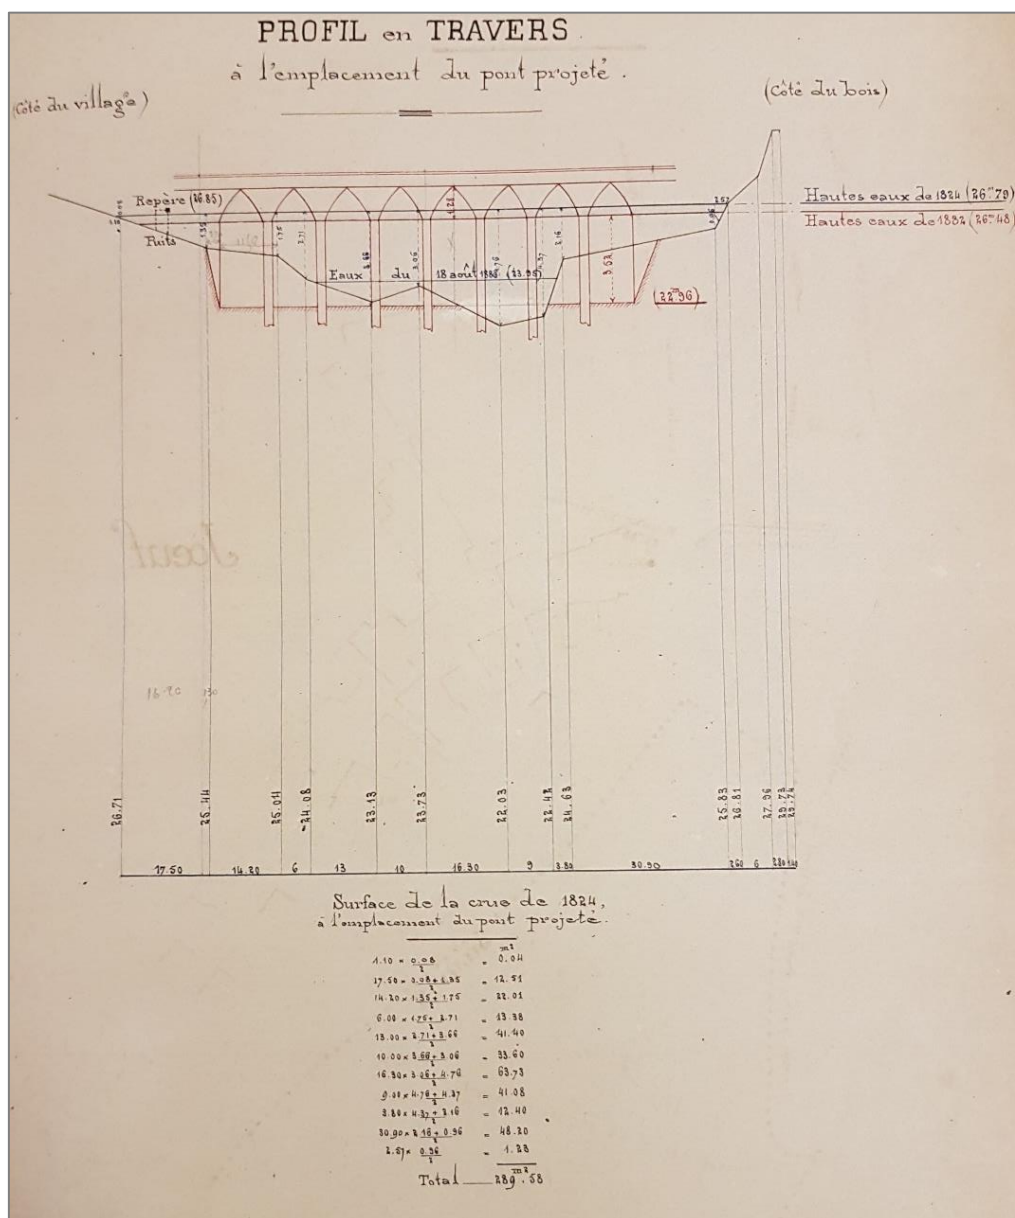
Profil en travers à l'emplacement du pont projeté sur l'Orne à Joeuf, octobre 1886. Les hautes eaux de 1824 (en bleu) et de 1882 (en rouge) sont représentées sur ce profil. La surface de la crue de 1824 a été calculée à l'emplacement du futur pont. (Source : AD 54 – 3S88)
